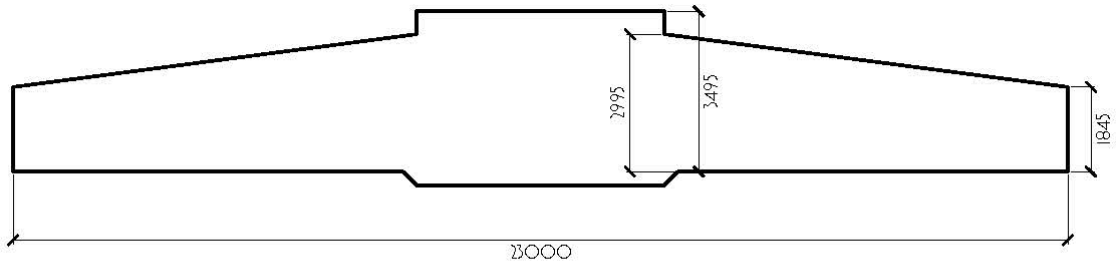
GEOMETRIA FONDAZIONE DIRETTA
